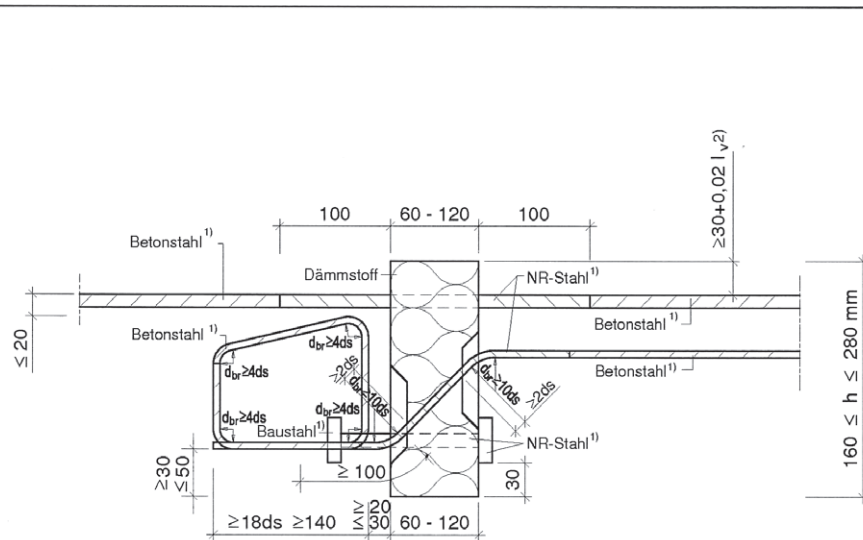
Schöck Isokorb Typ RKX-239 mit integrierter Aufhängebewehrung
